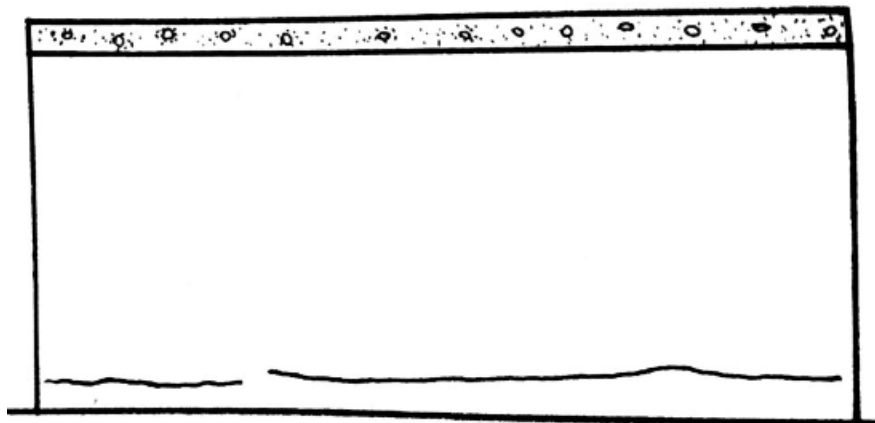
Trincas horizontais na alvenaria provenientes da expansão dos tijolos: o painel é solicitado à compressão na direção horizontal
